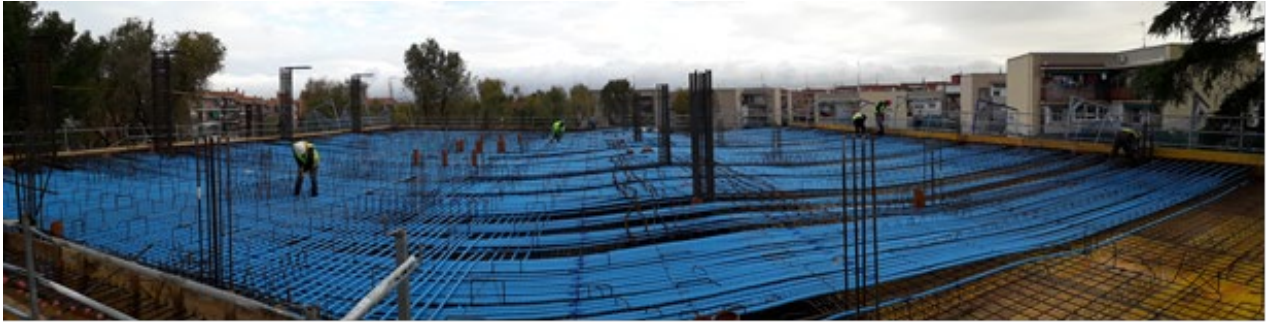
Vista trazado tendones monocordón en losa de 60cm para apeo de pilares sobre polideportivo.
